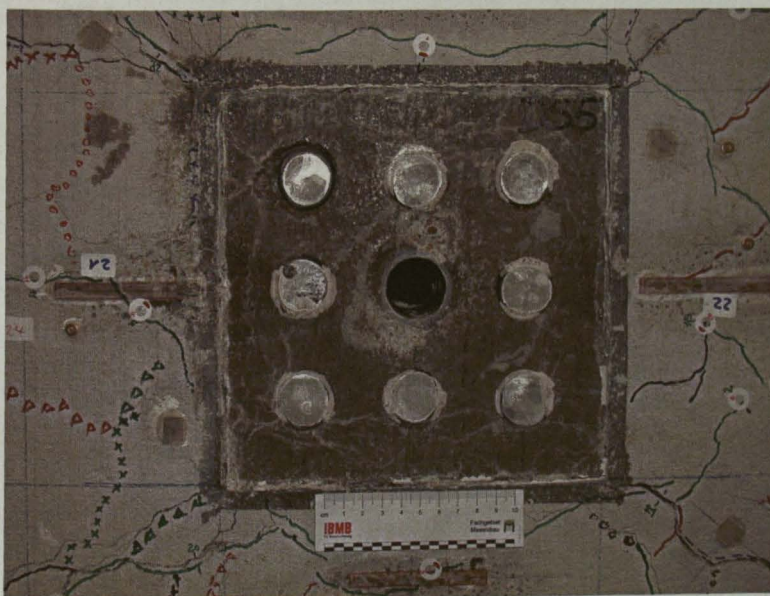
Detail Versuchskörper DS5 mit nachträglich eingebauten 8 \varnothing 26,5, nach dem Belastungsversuch
